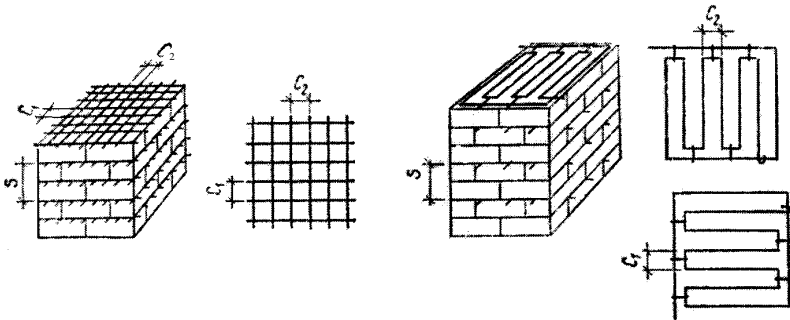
Непряме армування кам'яної кладки: а – прямокутними сітками; б – сітками «зигзаг»
